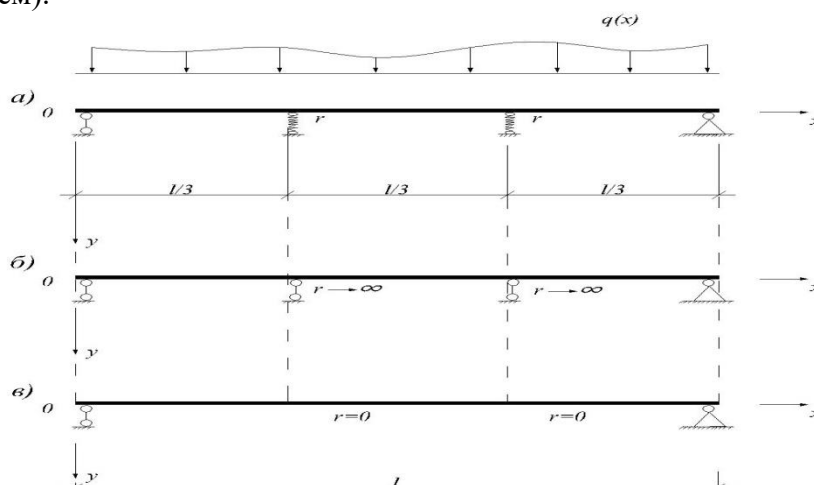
Расчетные схемы шпренгельной балки с двумя стойками
